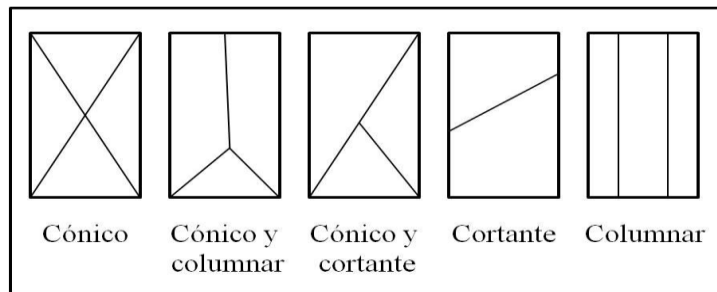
Planos de falla de cilindros de concreto (ASTM C-39)
